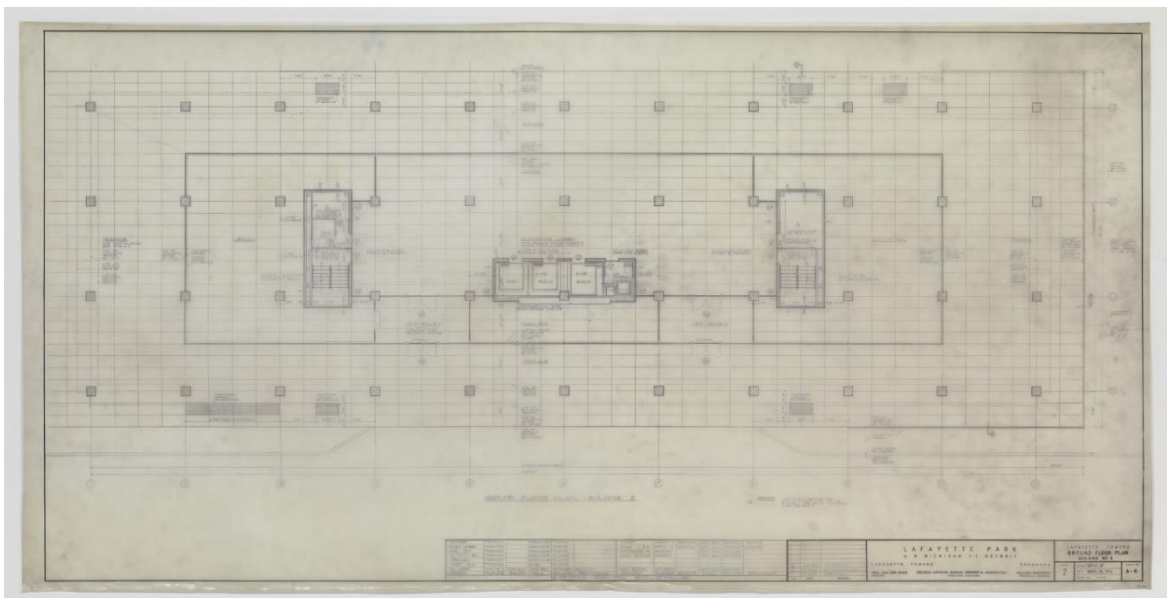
Planta do piso térreo, Lafayette Towers, Detroit, Estados Unidos da América, 1956
